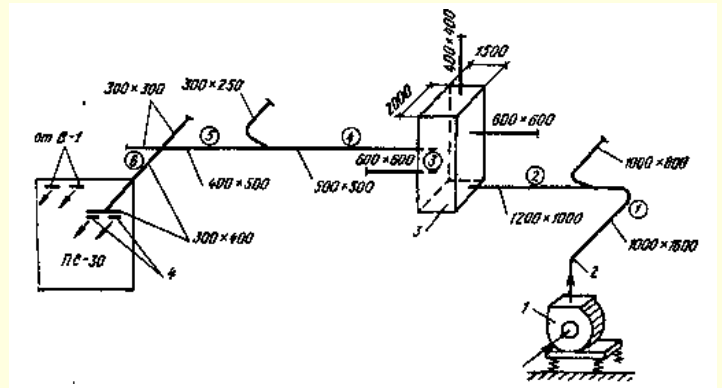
Схема расчетной ветви воздуховодов (к примеру 4.16): 1 – вентилятор; 2 – плавный поворот; 3 – камера статического давления; 4 – жалюзийная решетка
